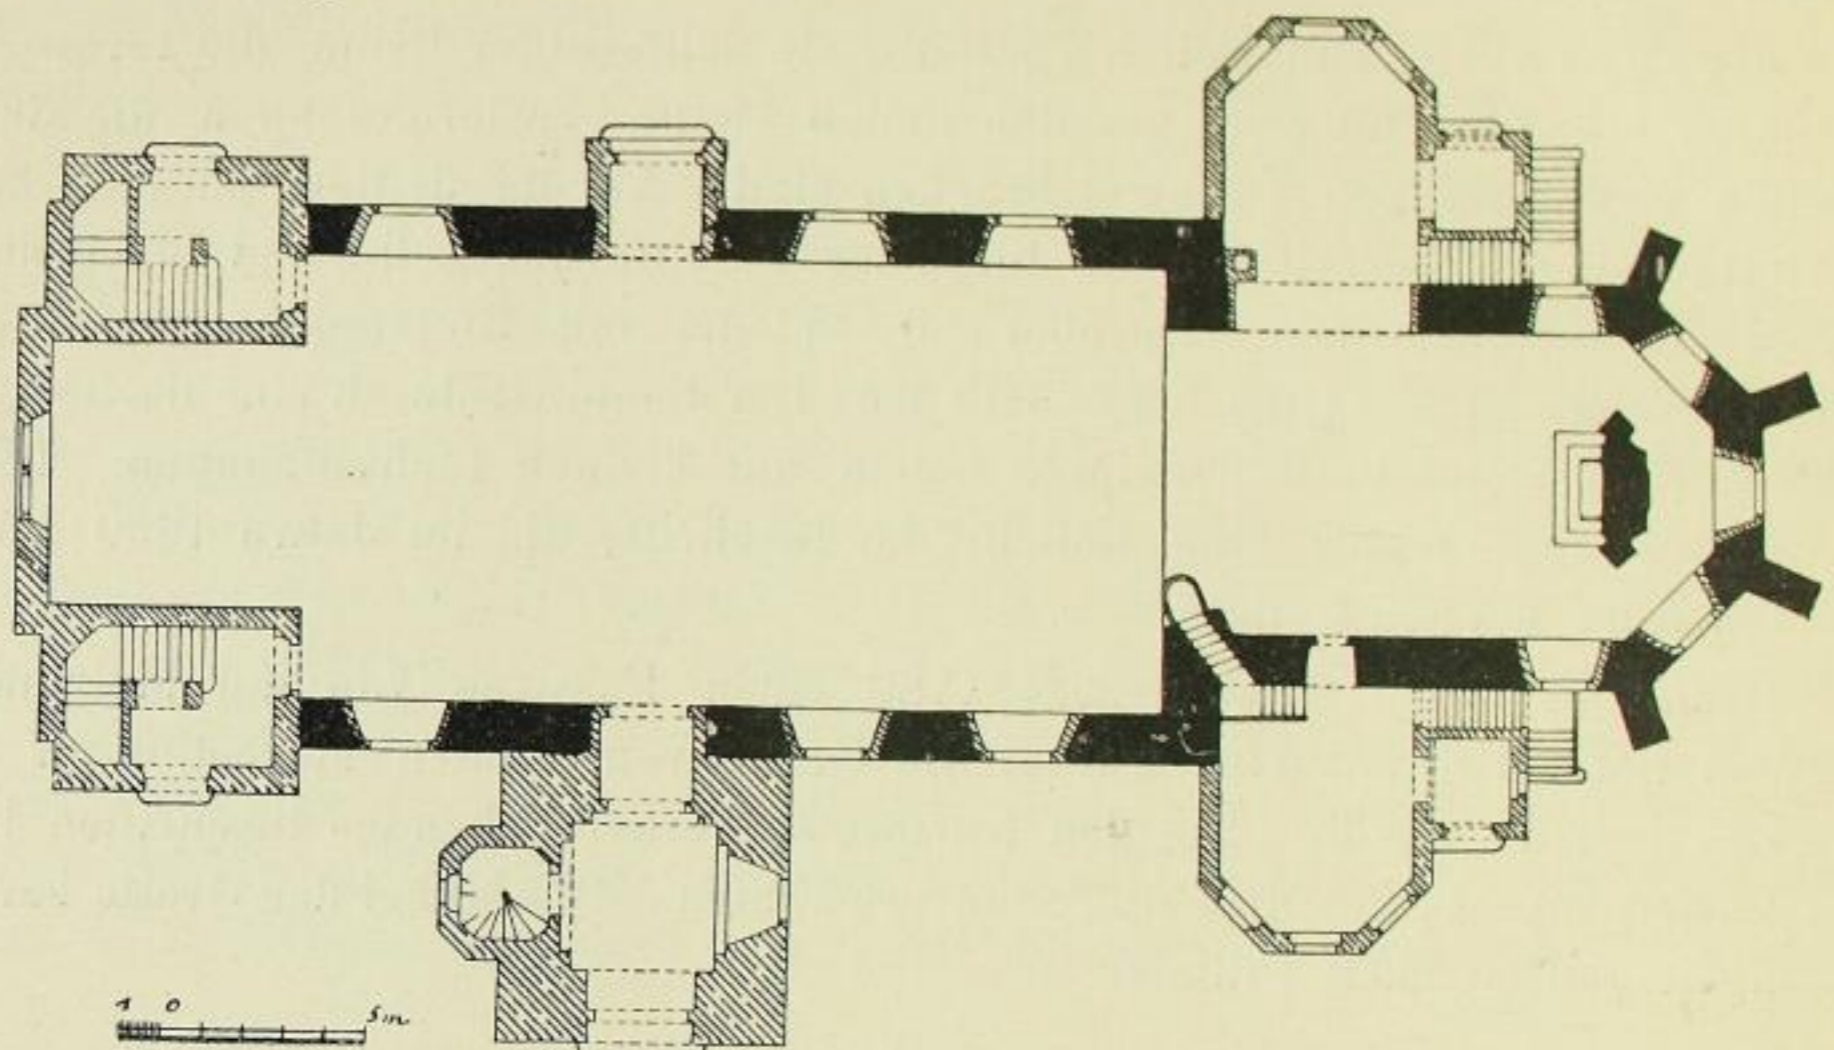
Radeberg, Grundriss der Kirche.
